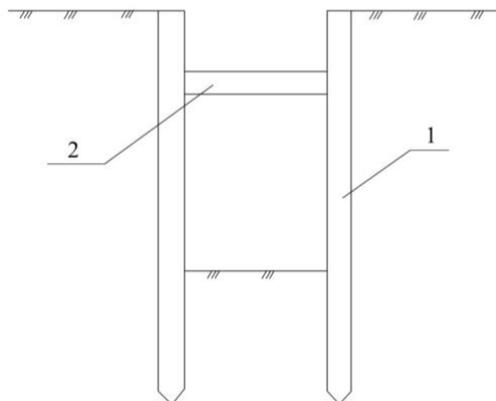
Схема шпунтового ограждения стенок траншей:
